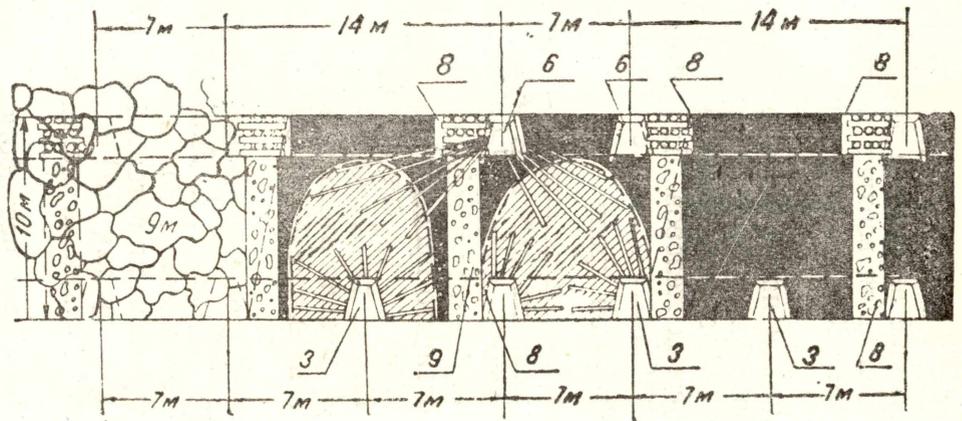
Система разработки полосами по падению с податливой бетонной крепью
